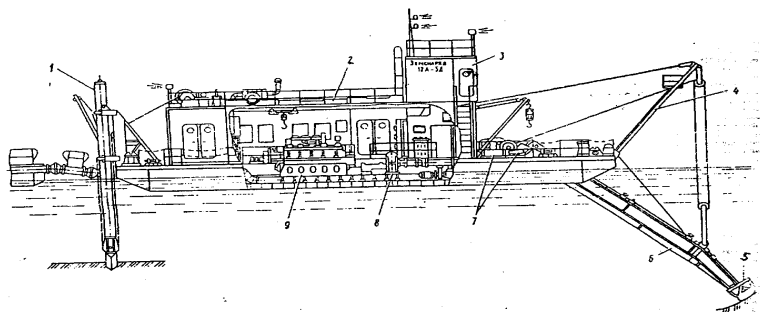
Землесосный снаряд: 1 – свайный аппарат; 2 – надстройка; 3 – рубка управления; 4 – стрела; 5 – рыхлитель; 6 – рама с всасывающей трубой и фрезерным рыхлителем; 7 – папильонажные и рамоподъемные лебедки; 8 – грунтовый насос; 9 – привод насоса.
